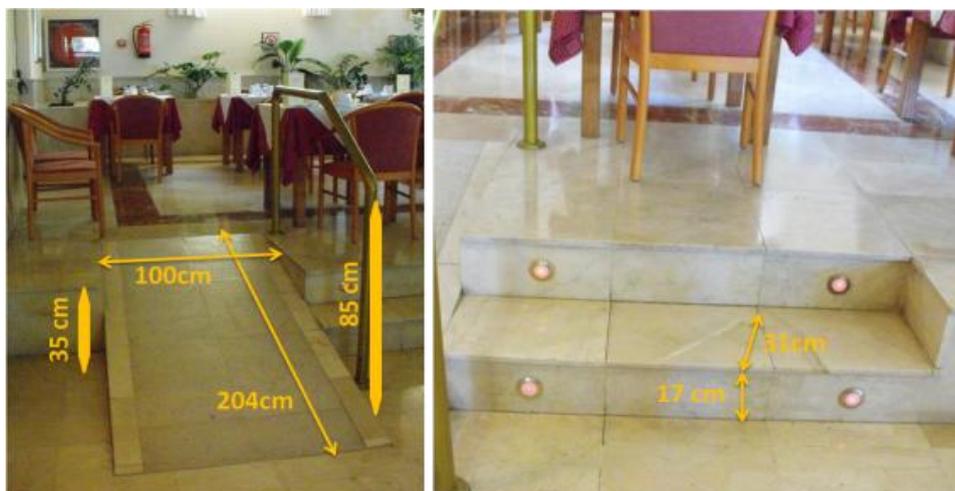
Detalles de la rampa y escaleras que conectan el comedor y la zona de bufé en el hotel Gran Rey
